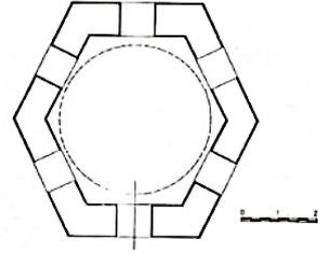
مسقط أفقي لتربة السلطان مراد الثالث في
